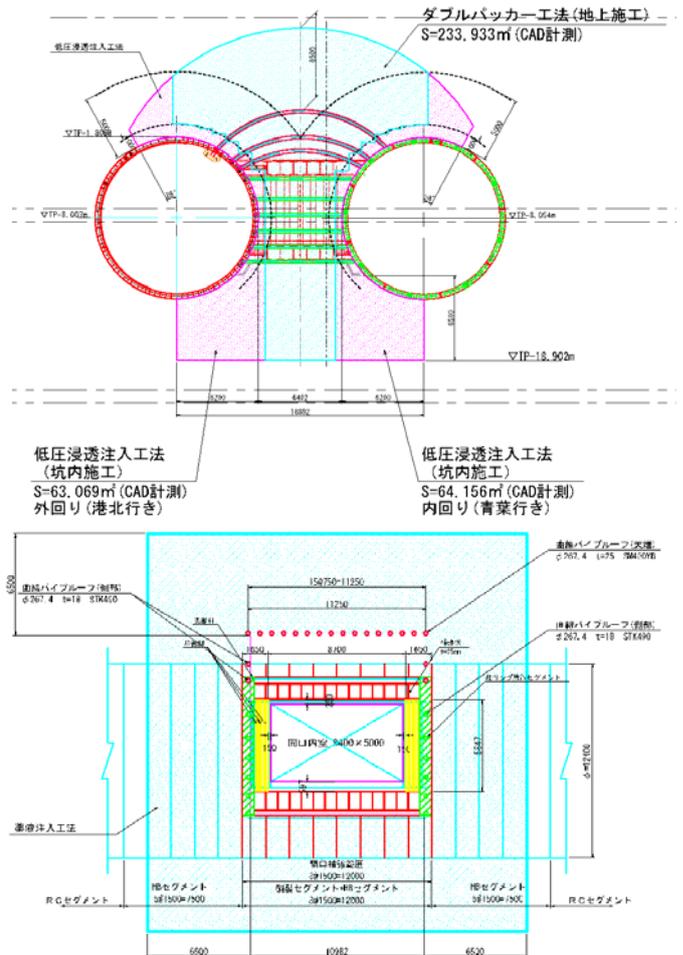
パイプルーフ・薬液注入工施工図 (縦断・横断面)
